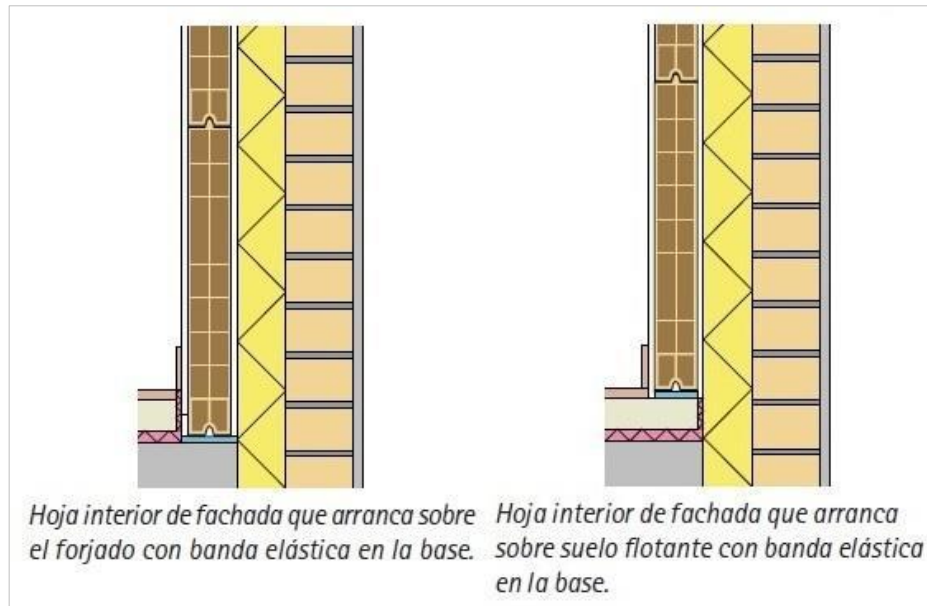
Tipos de arranque de las hojas interiores de fachada con banda elástica
